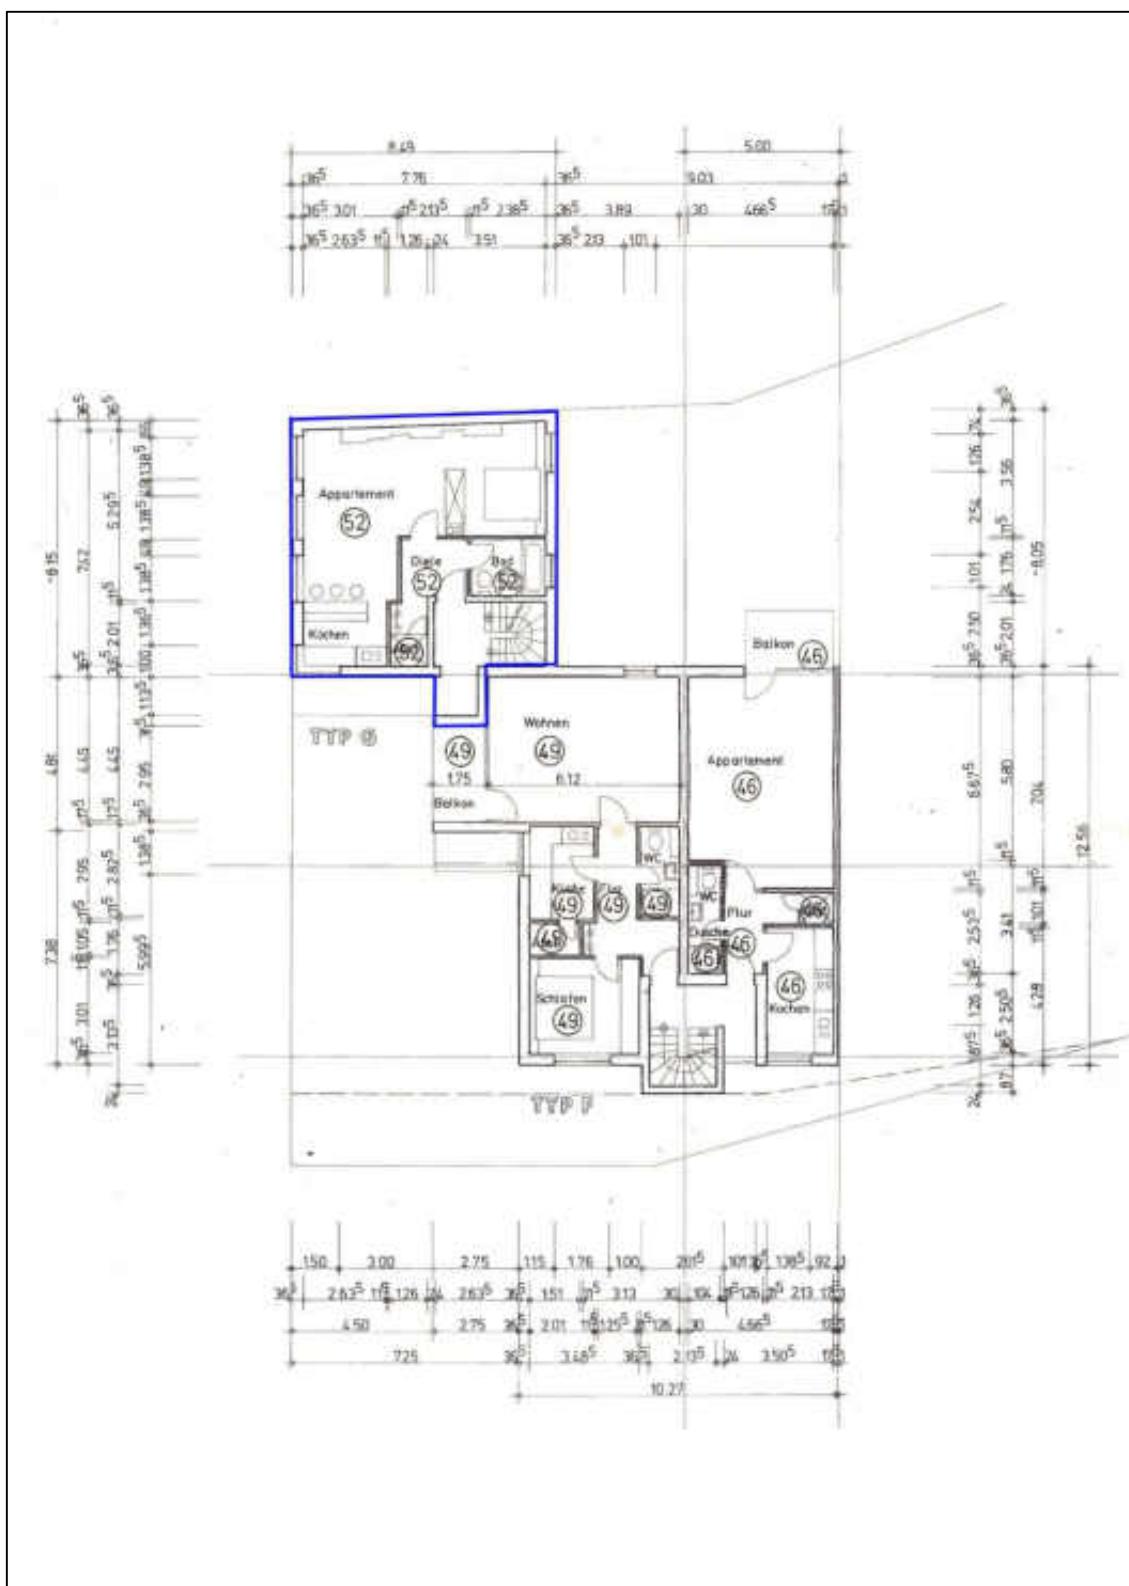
Grundriss vom 1. Obergeschoss Gebäudetyp G
